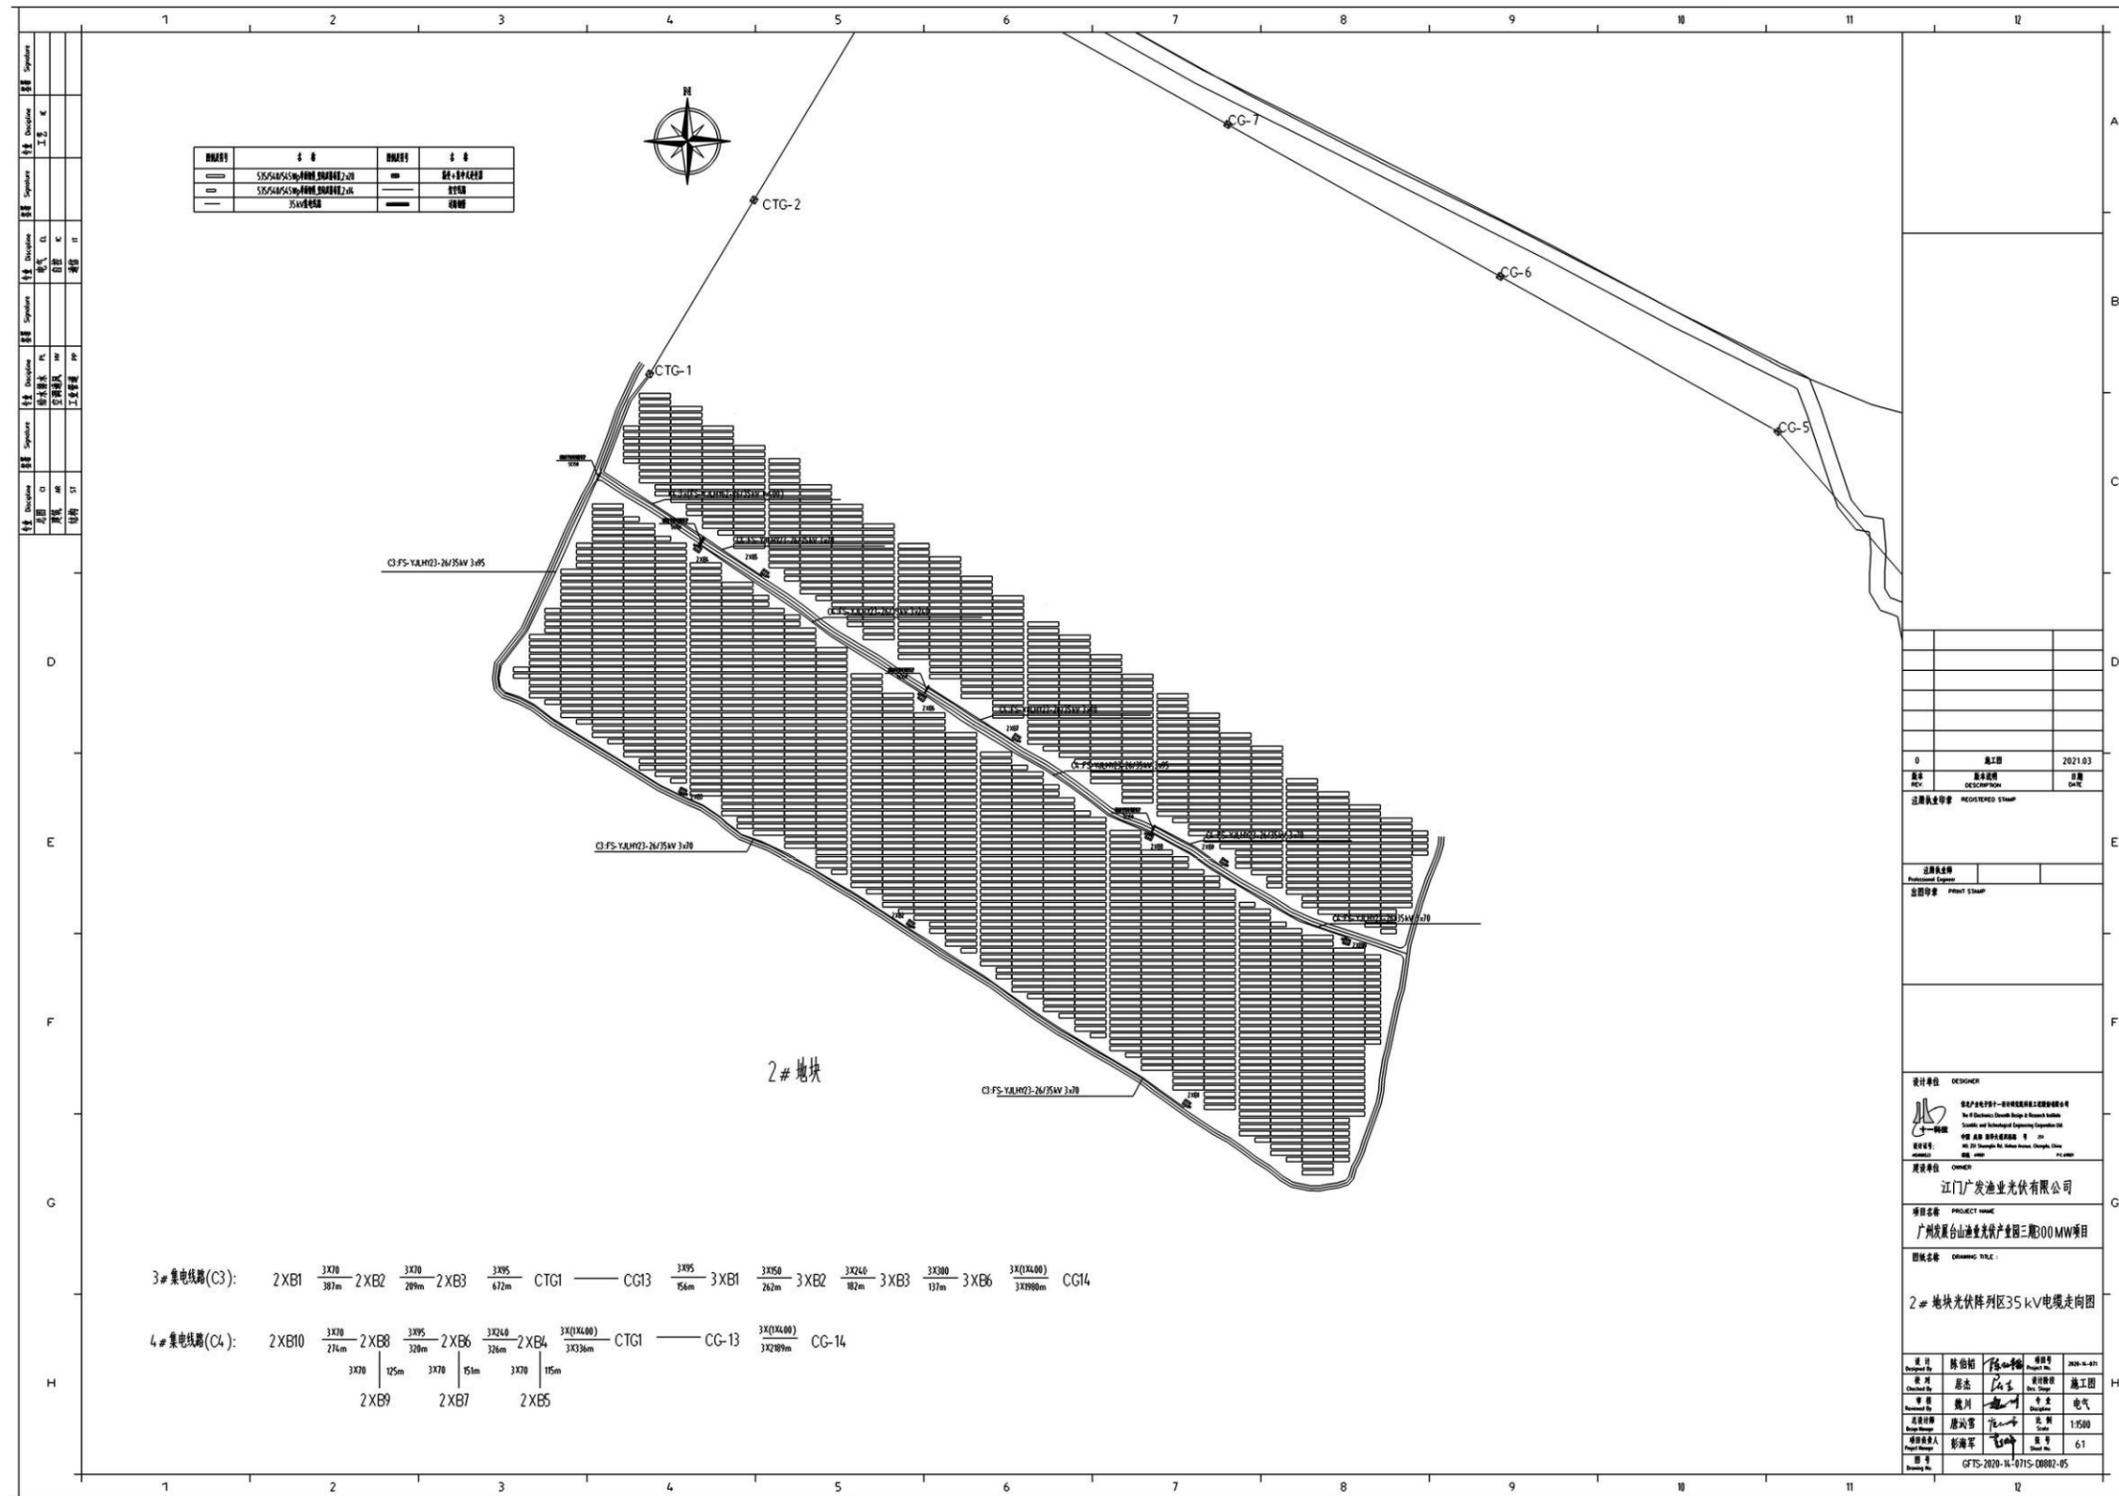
光伏区平面布置图 (A11-A12)
